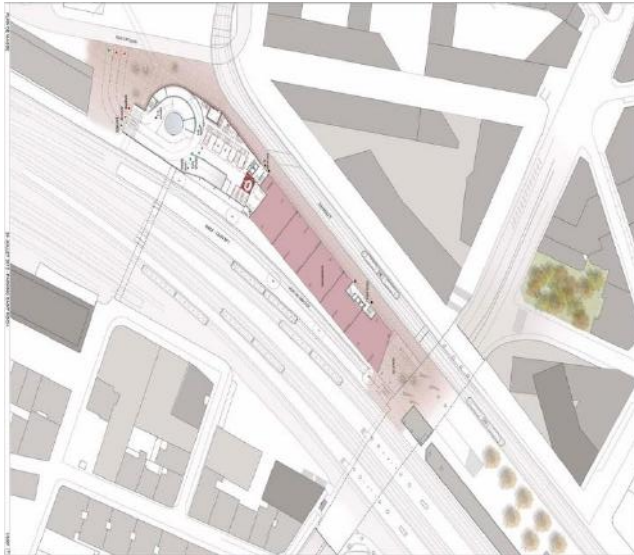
Plan Rdc de Parking - Source : archdaily.
